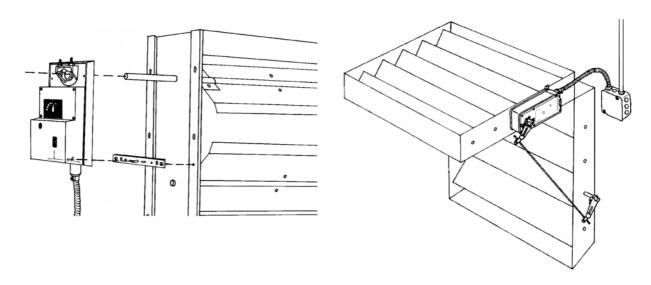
Установка и крепление исполнительного механизма на воздушный клапан
